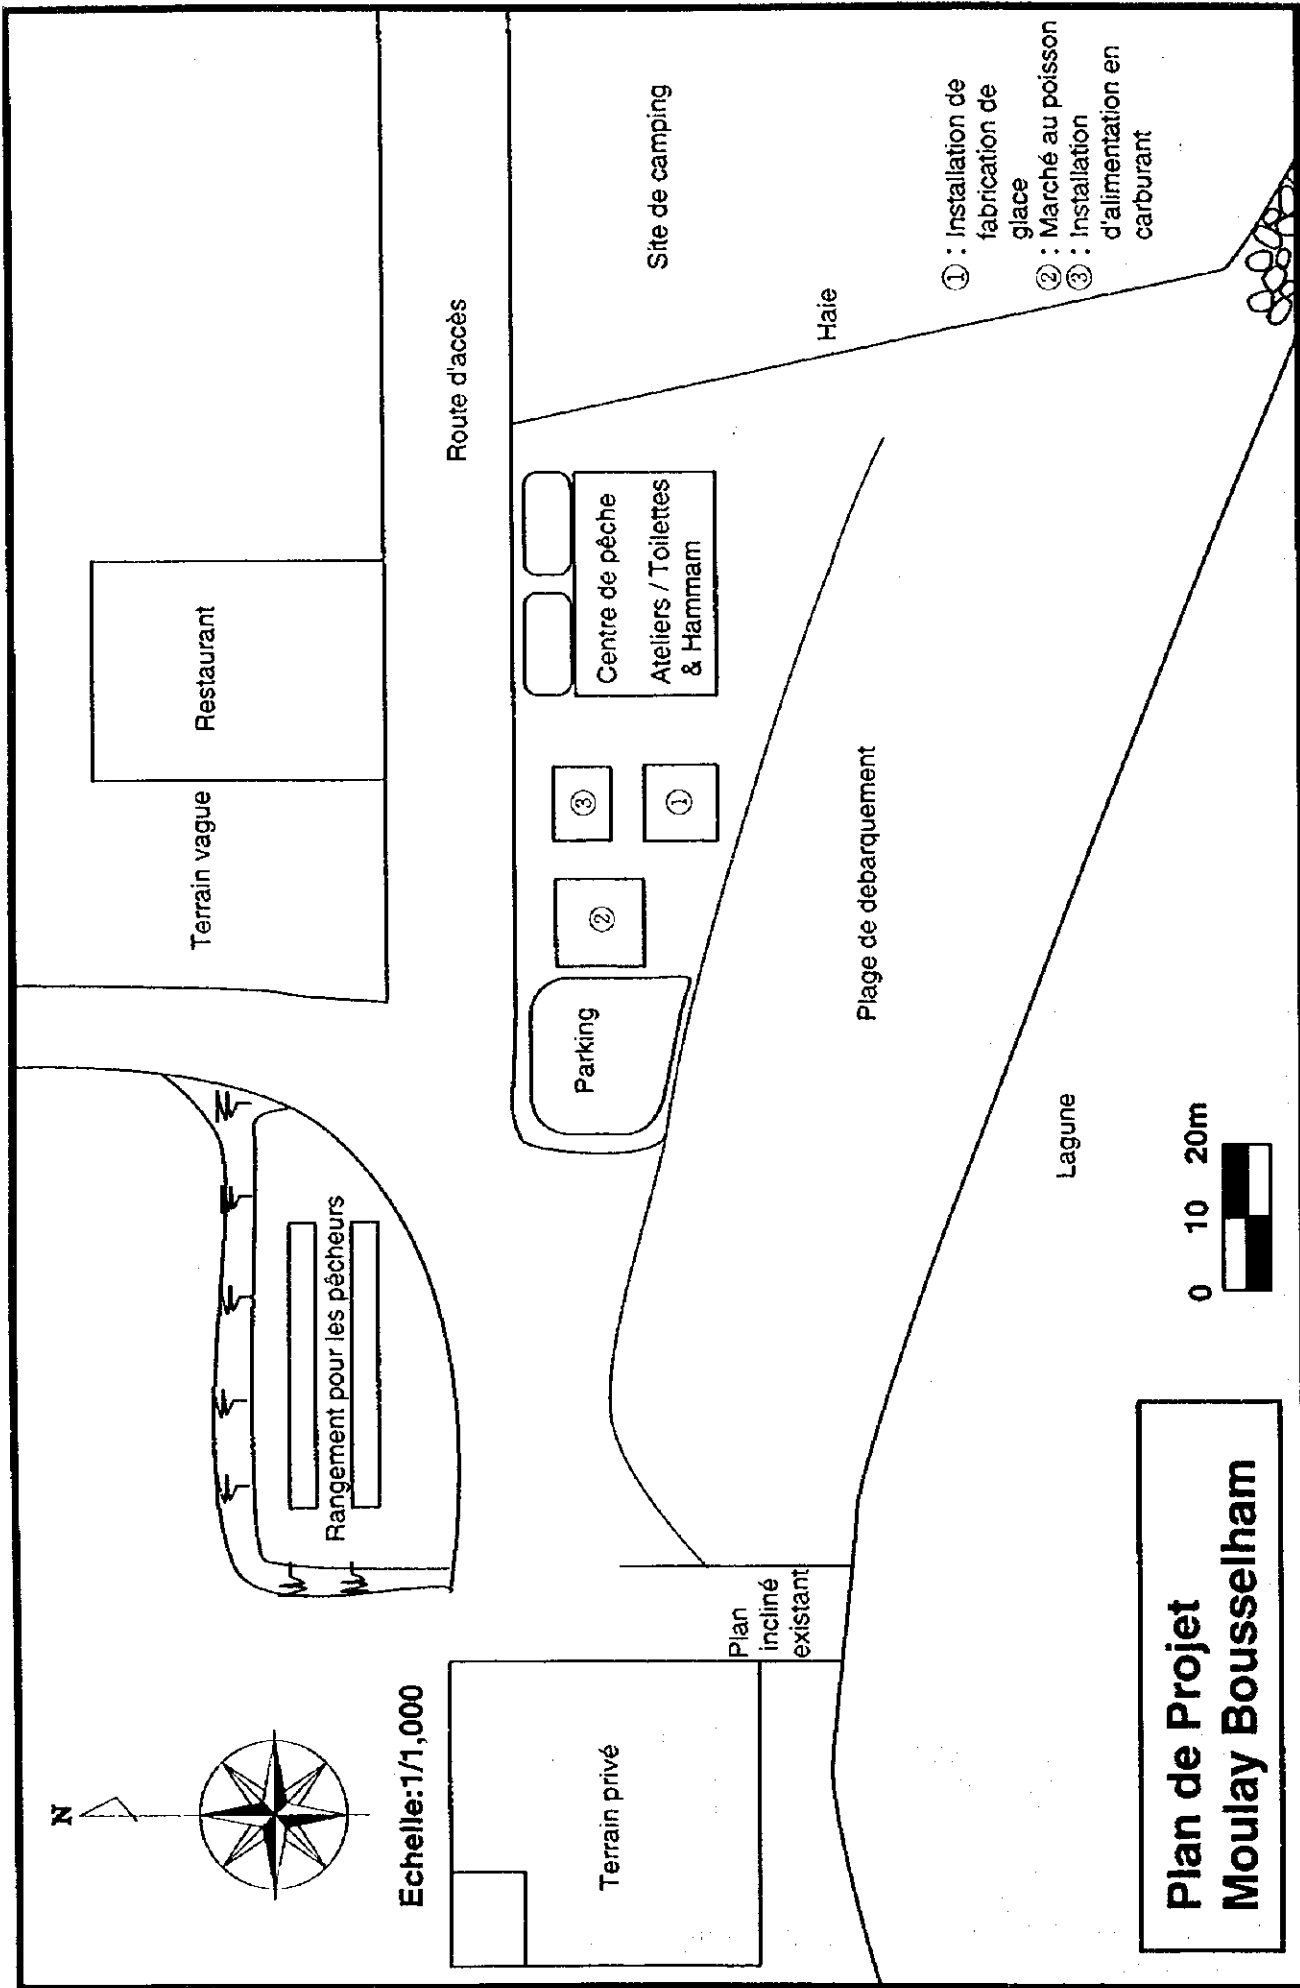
F-3 Projet de disposition des installations à Moulay Bouselham (2)
